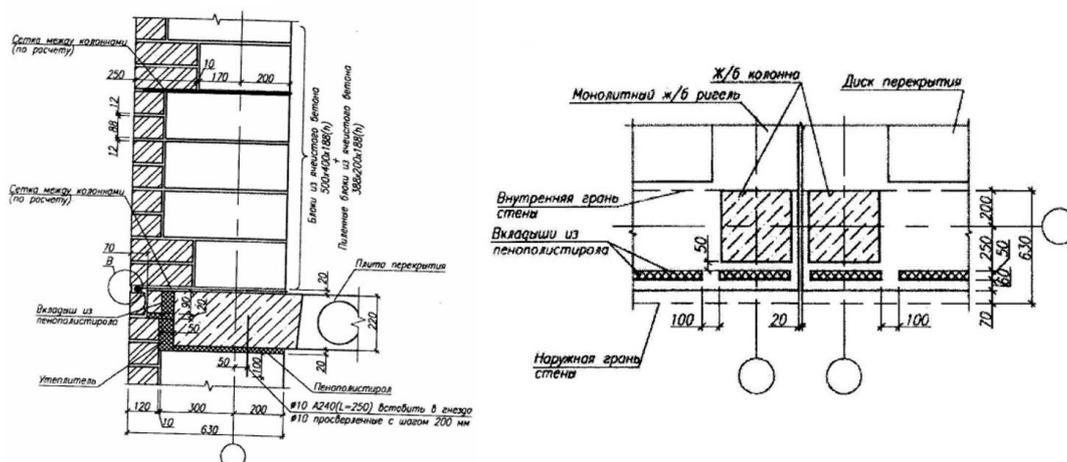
Опирание наружных стен на ригели и дискретная теплоизоляция ригеля
